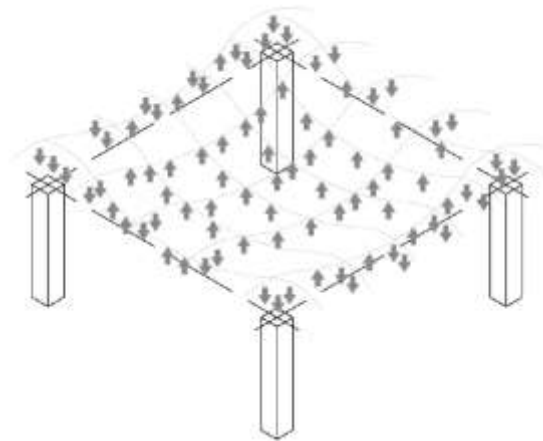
Trazado del tendón de la viga continua hiperestática
